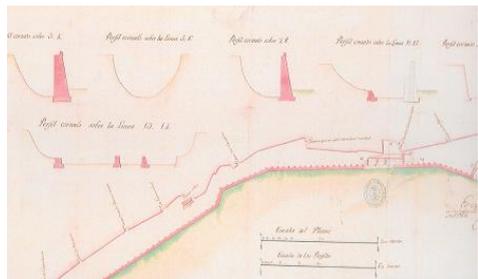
Detalle del Plano y Perfiles de los destrozos de la muralla de fecha 06.04.1792. SHMM, CA 30.16
